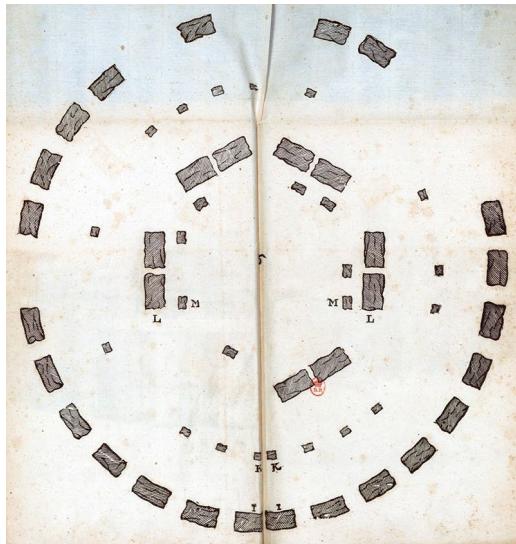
Inigo Jones, Pianta dello stato di fatto del sito di Stonehenge. Jones 1655, p. 64].
